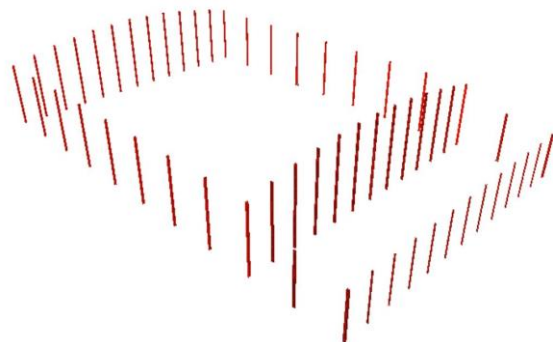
Fase 1 – Ejecución de los pilares metálicos de la estructura para envolverte del edificio. Fuente: Propia.
